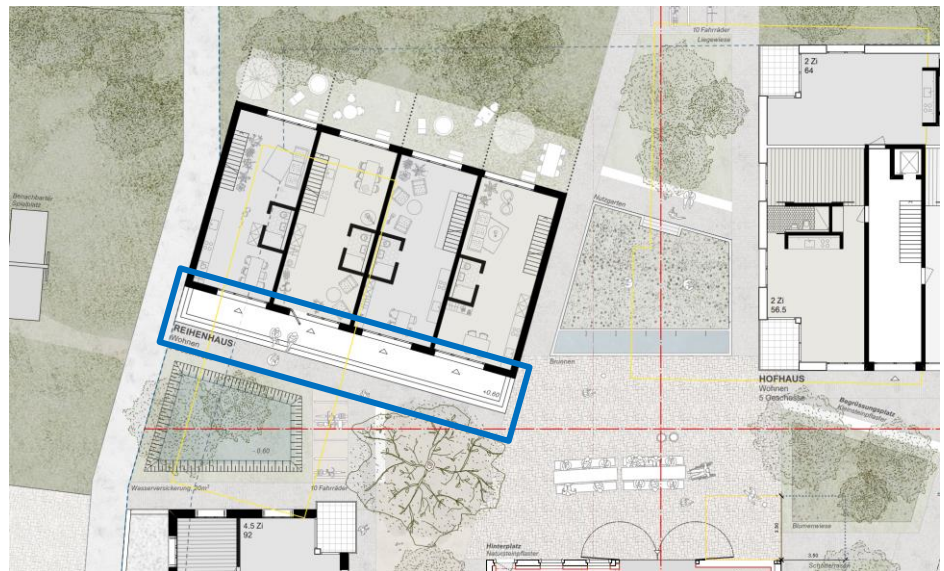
Ausschnitt Richtprojekt, Erdgeschoss und Umgebung
